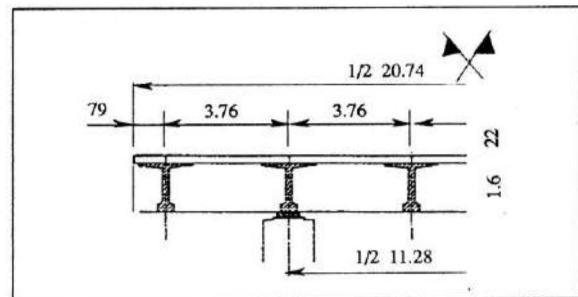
Section type. Demi coupe transversale type du pont sur appui et géométrie des poutres longitudinales et des entretoises. Ces dernières sont disposées régulièrement sur chaque appui.
